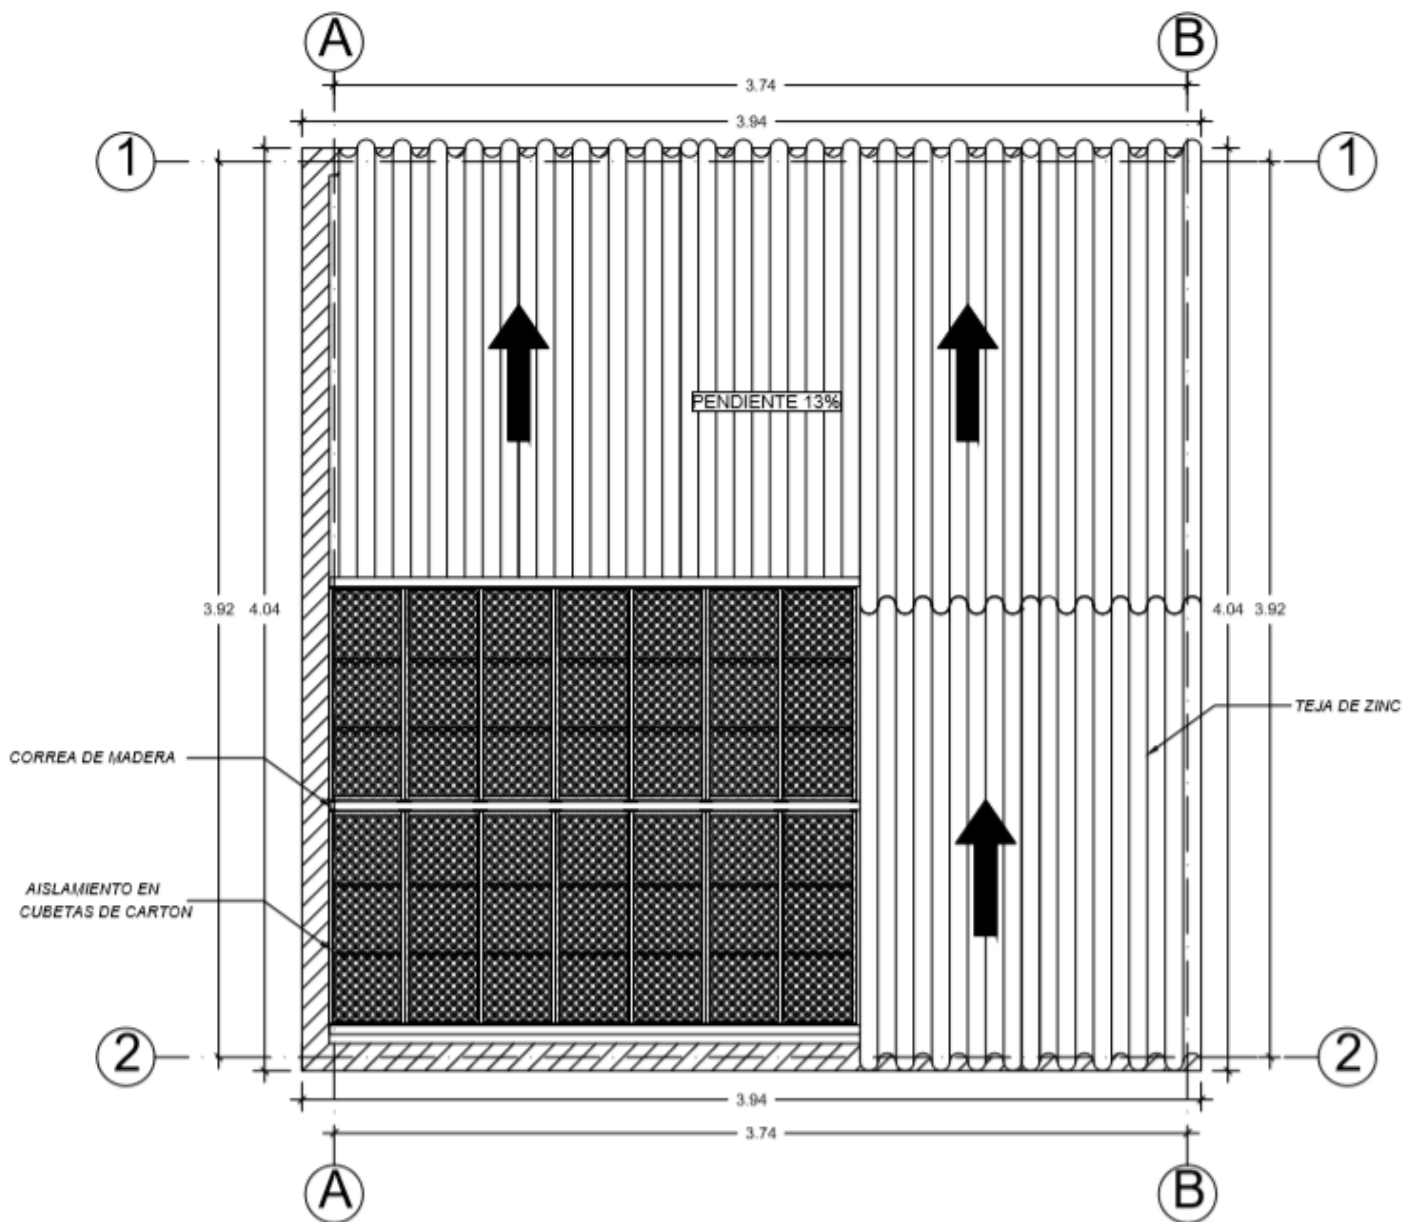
Planta de cubierta con aislamiento acústico. En la presente figura podemos determinar cómo van ubicados los paneles en la estructura del tejado de zinc recalcando que se implementan los paneles #1. Elaboración propia.
